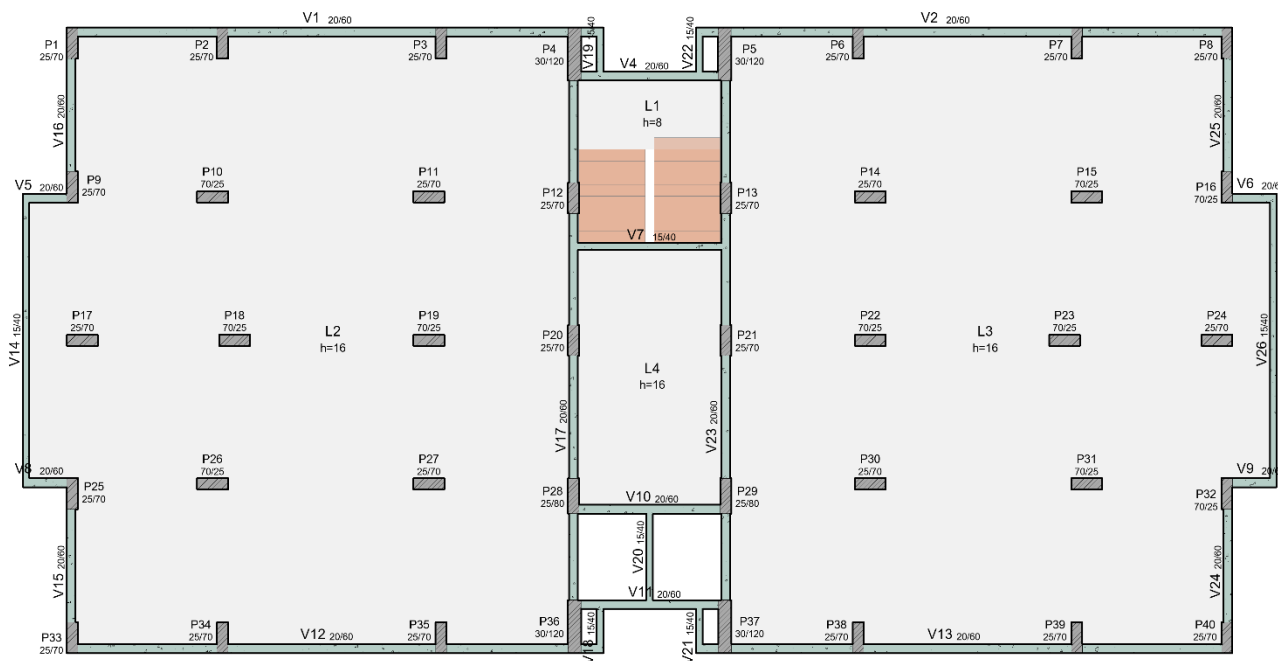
Planta de forma do pavimento tipo caso B. (Fonte: Autor; 2022)
